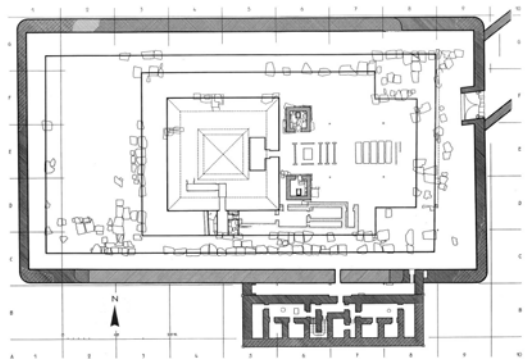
Grundriss Sonnenheiligtum Userkaf
